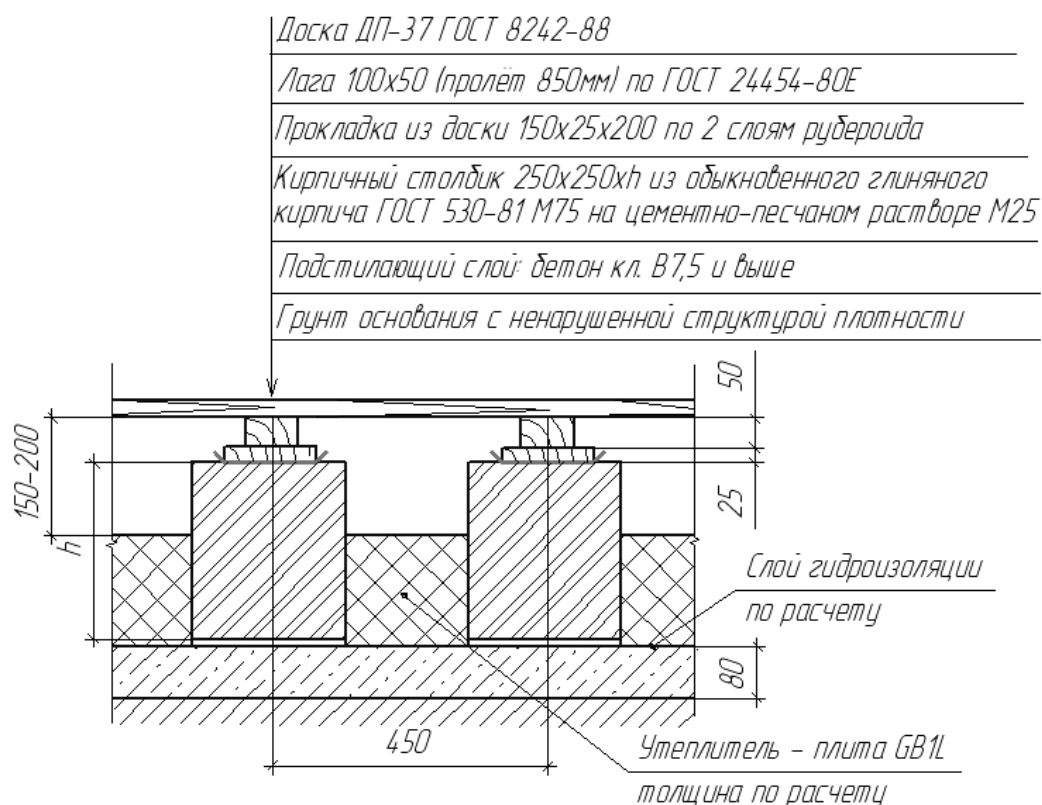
Конструкция дощатого пола по грунту с утеплением на кирпичных столбиках с применением системы плит GREEN BOARD®
